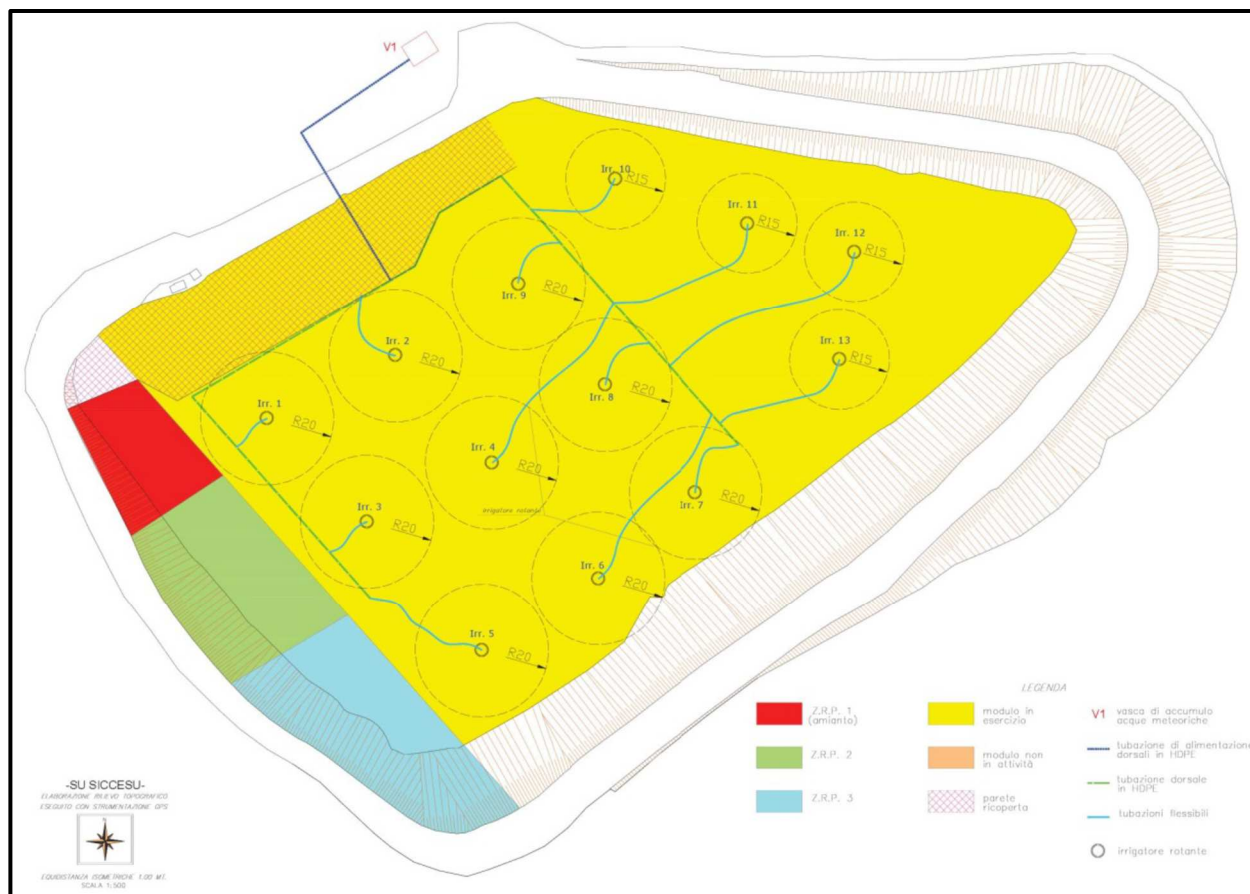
/VI: Schema Planimetrico impianto di - contenimento emissioni diffuse
